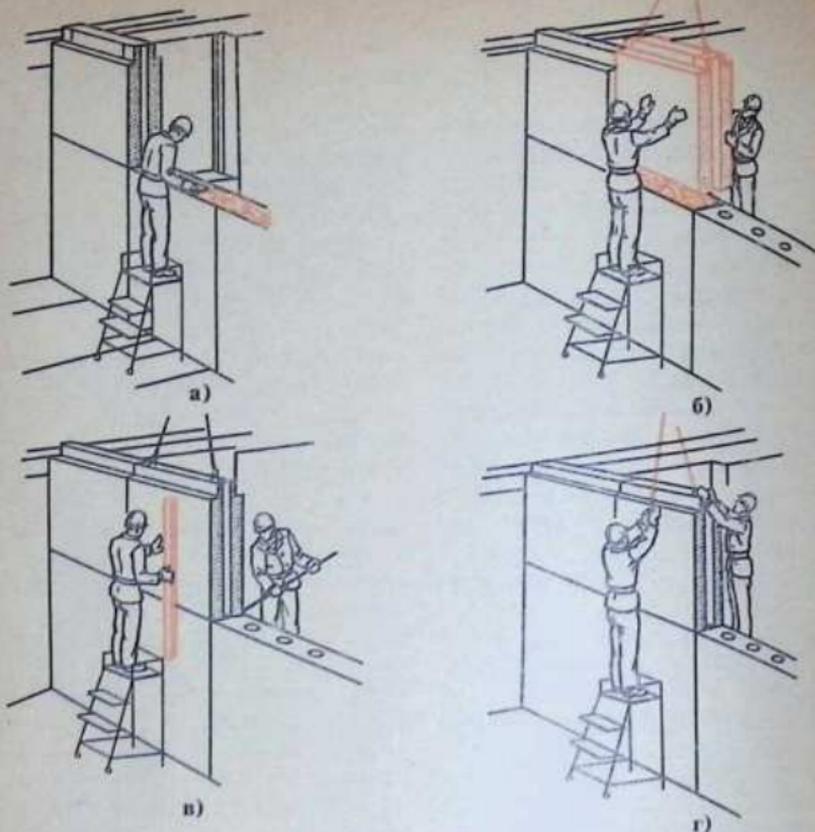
Монтаж блоков внутренних стен: а — подготовка растворной постели, б — наводка блока, в — выверка, г — расстроповка
